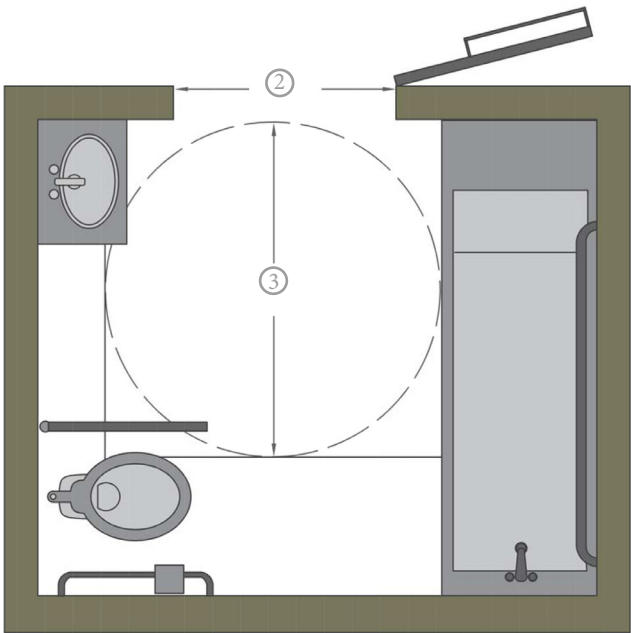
2 Baño con inodoro en esquina con tina - Planta
